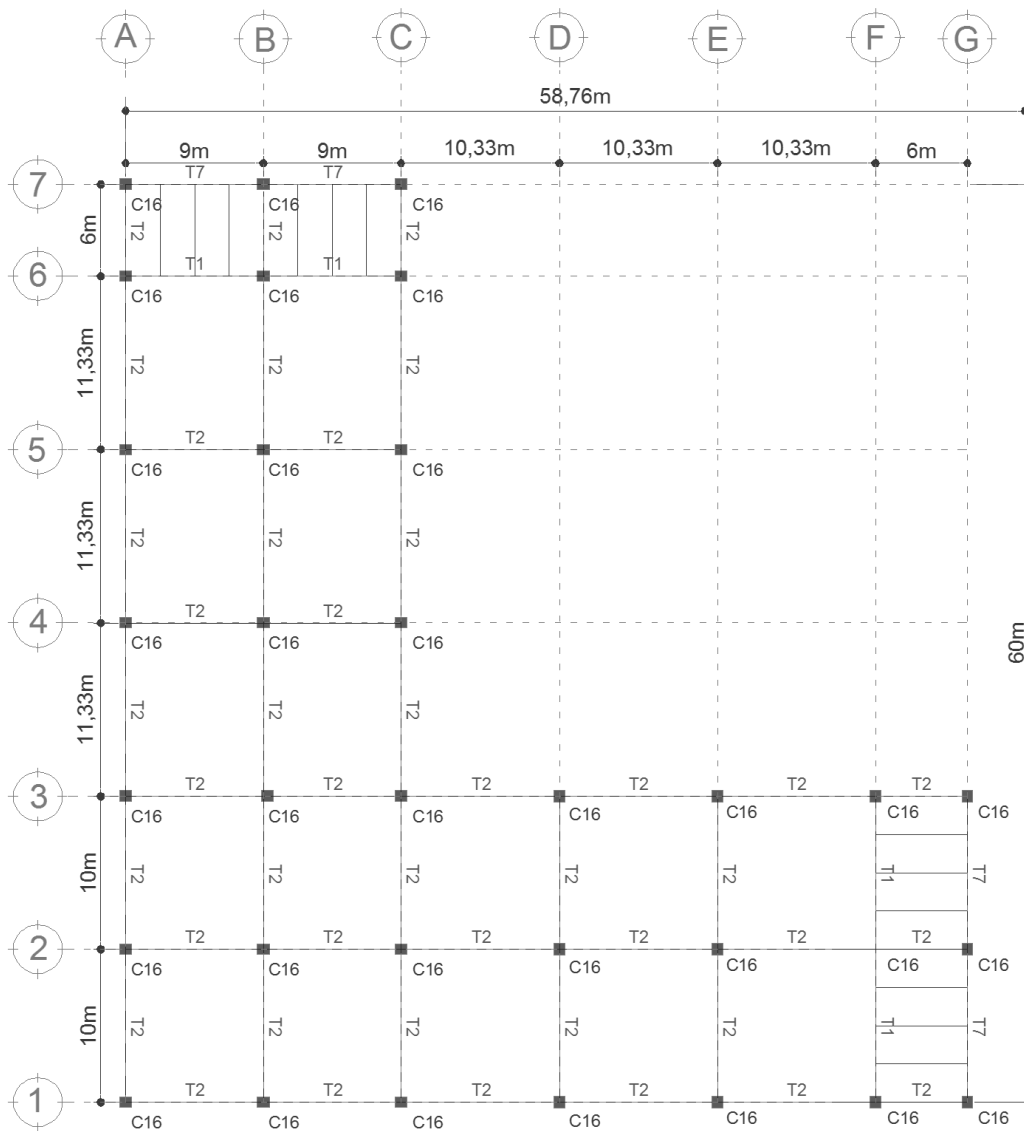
Distribución de columnas y traves en los niveles 8 y 9.
